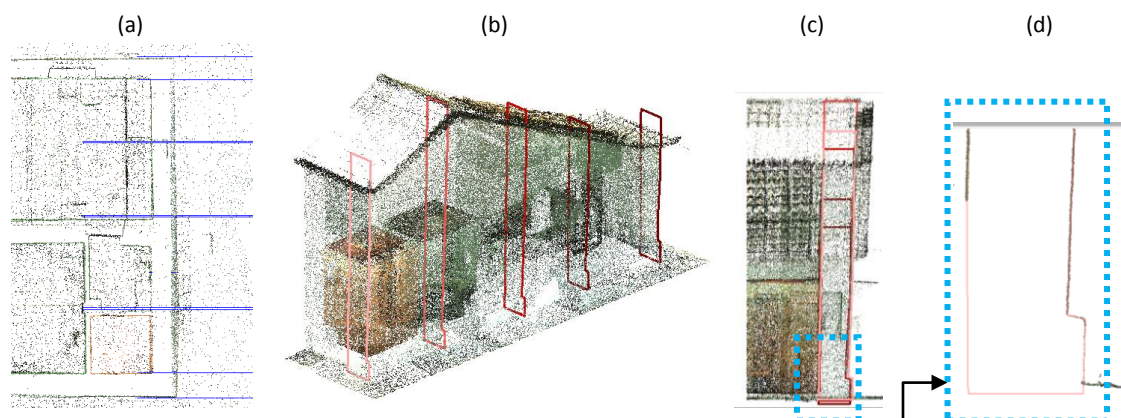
Indicação das paredes modeladas no AutoCAD e substituídas posteriormente
